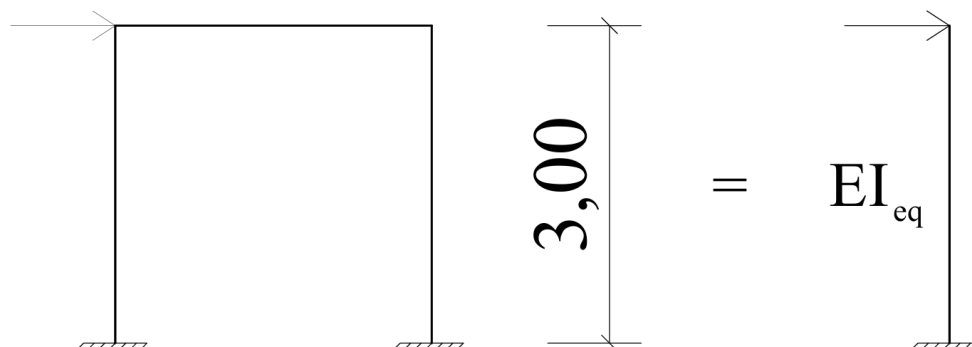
Rigidez Equivalente a de um Pórtico de um pavimento
